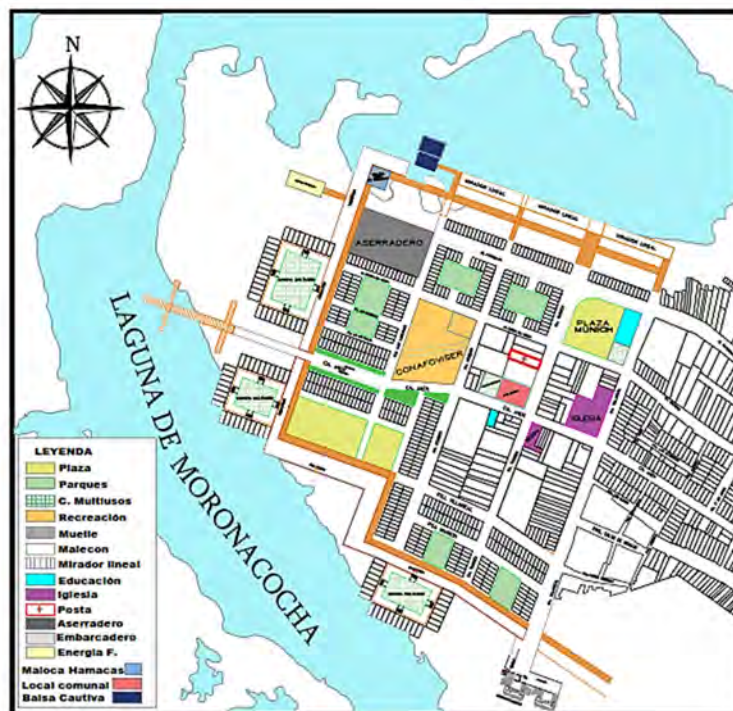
PLANTA GENERAL- ZONIFICACIÓN
